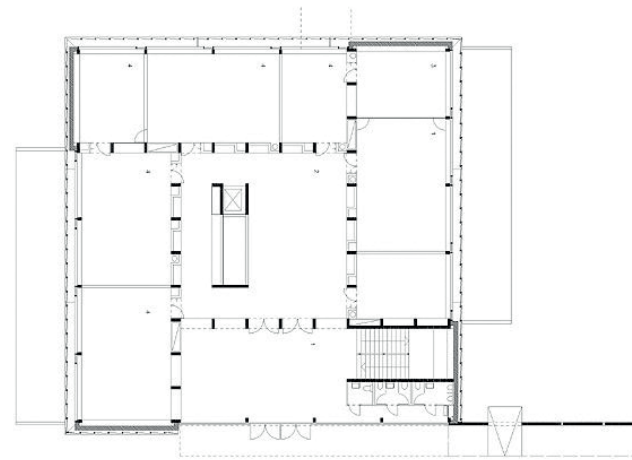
Hauptschule Mäder Grundriss OG
